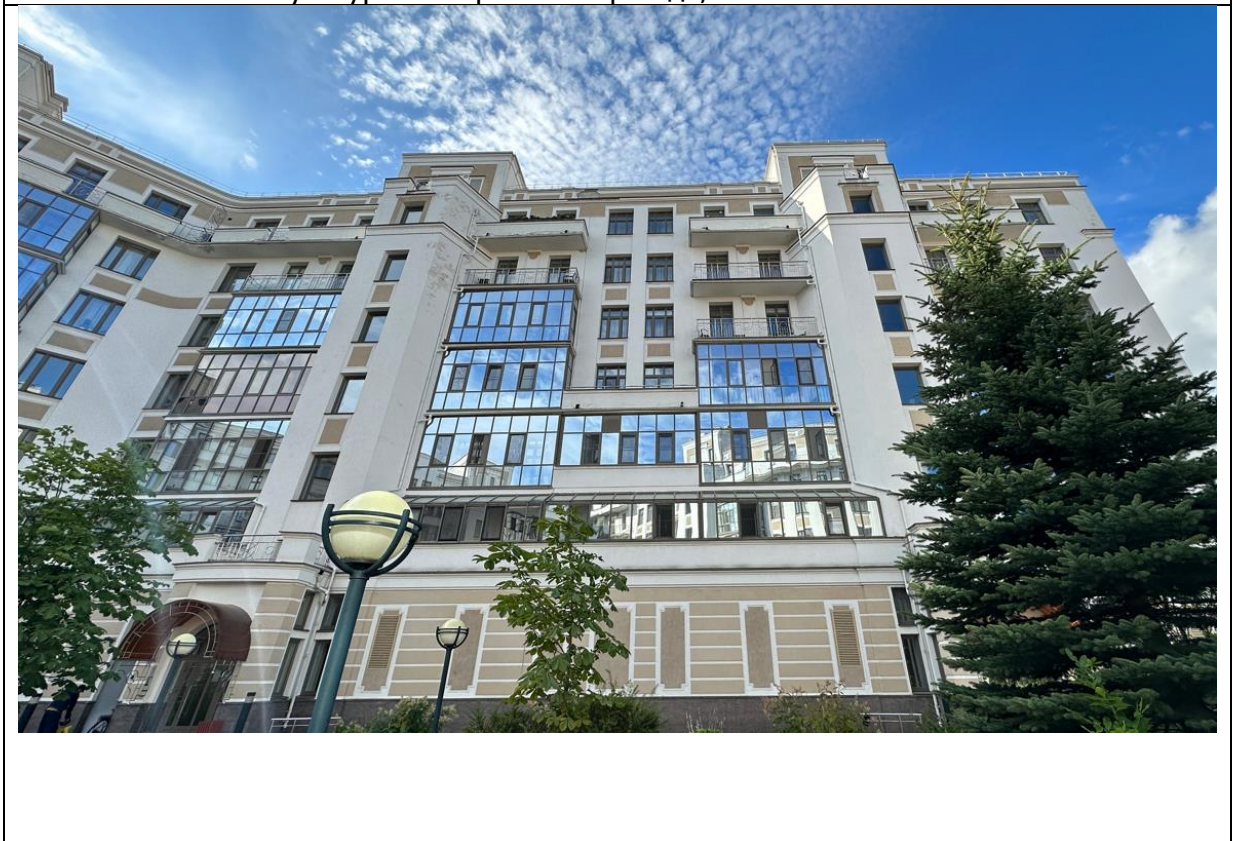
Общий вид дворовой части фасада здания и дефекты в виде растрескивания штукатурки и окраски на фасаде, откосах и балконах
